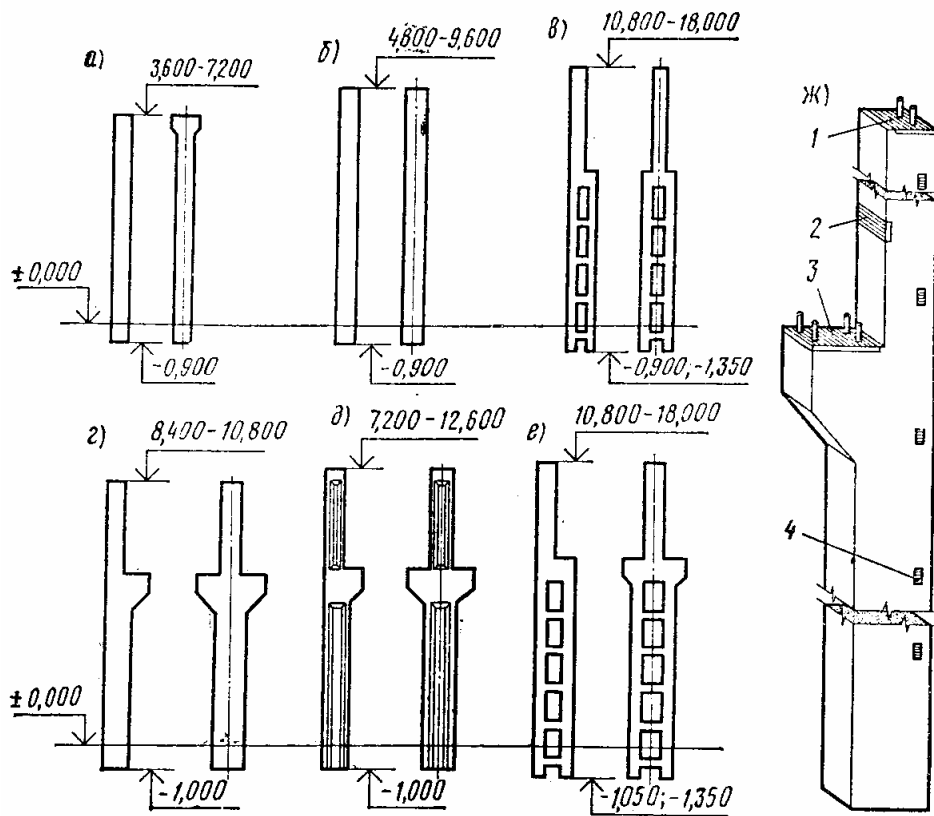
Железобетонные колонны одноэтажных промышленных зданий: а – прямоугольного сечения для зданий без мостовых кранов при шаге 6 м; б – то же, при шаге 12 м; в – двухветвевые для зданий без мостовых кранов; г – прямоугольного сечения для зданий с мостовыми кранами; д – то же, двутаврового сечения; е – двухветвевые для зданий с мостовыми кранами; ж – общий вид колонны; 1 – закладная деталь для крепления несущей конструкции покрытия; 2, 3 – то же, подкрановой балки; 4 – то же, стеновых панелей
